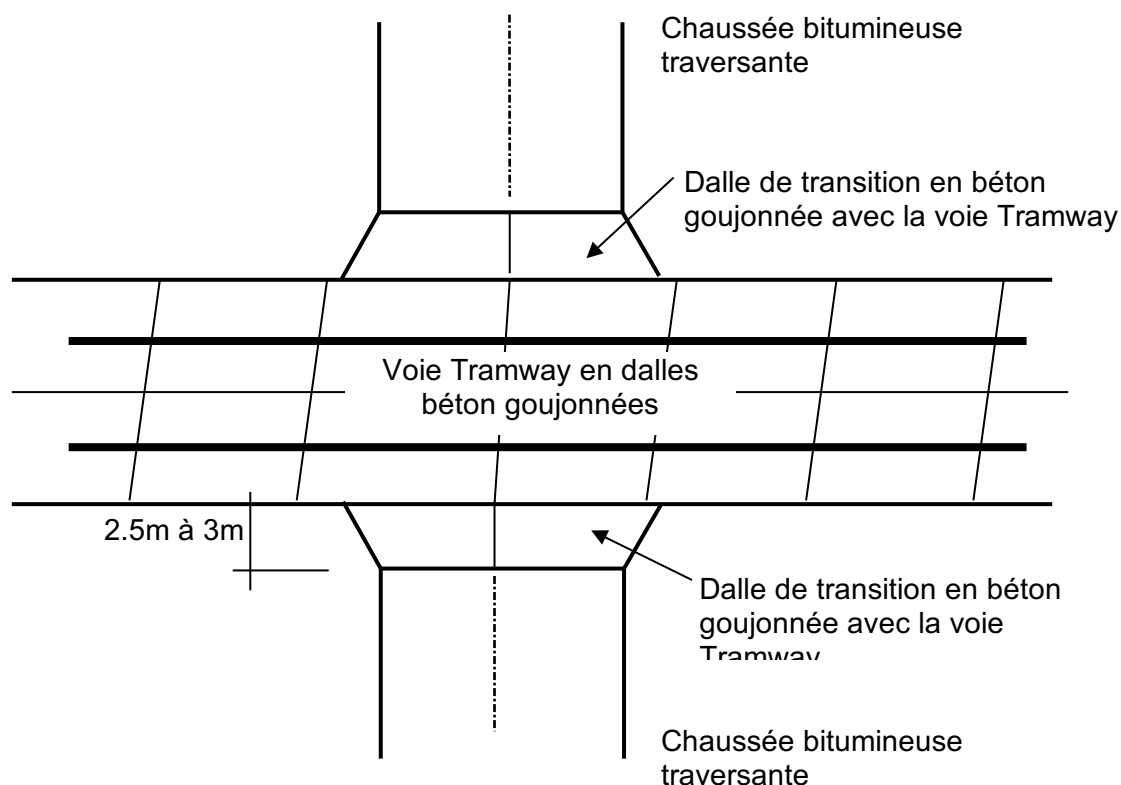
Raccordement de la voie Tramway avec les chaussées traversantes – vue de dessus, schéma de principe
